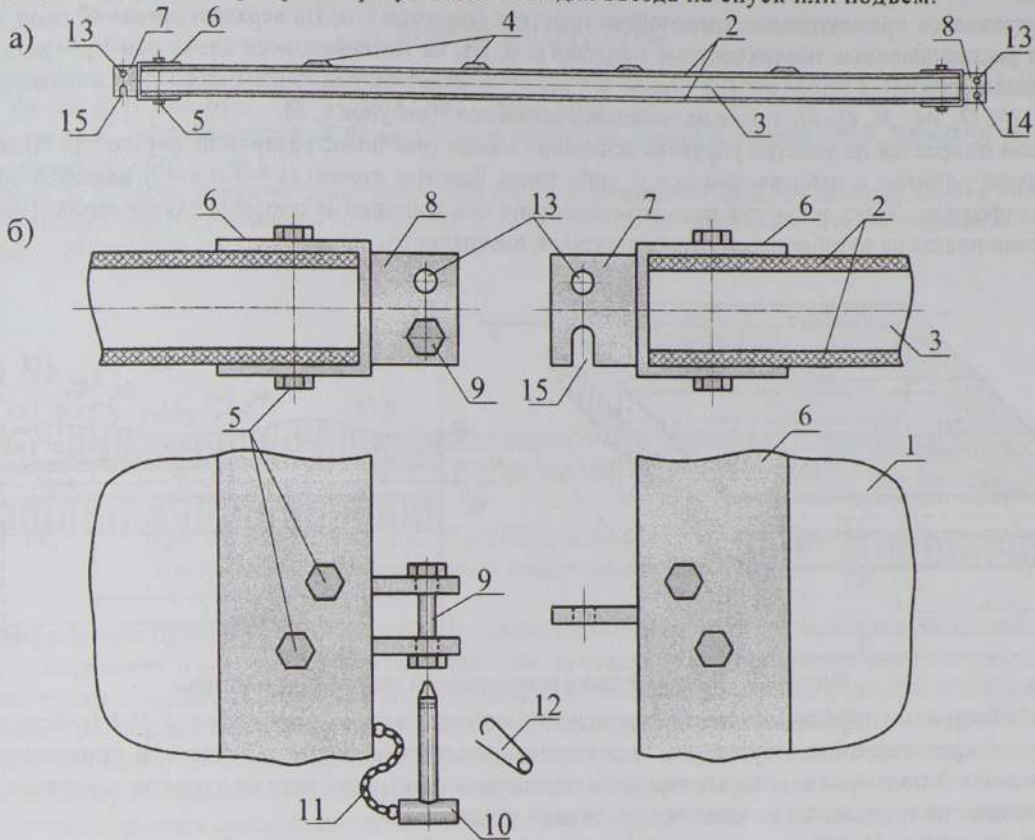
Конструкция сборно-разборной дорожной площадки:
